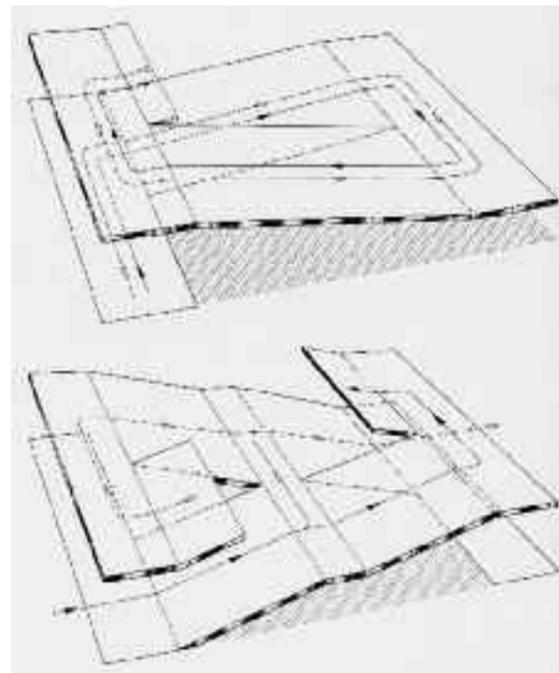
Schemazeichnung einfache Parkkrampengarage (oben) und mit Übergang in der Mitte (unten) (Aus: DBZ 8, 1960)
